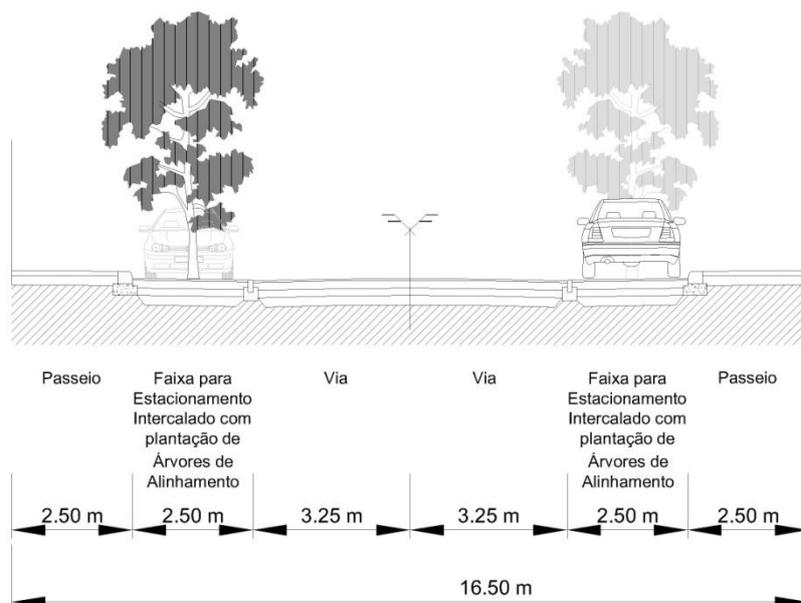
Perfil Transversal Tipo da via circular da SP 9.b
